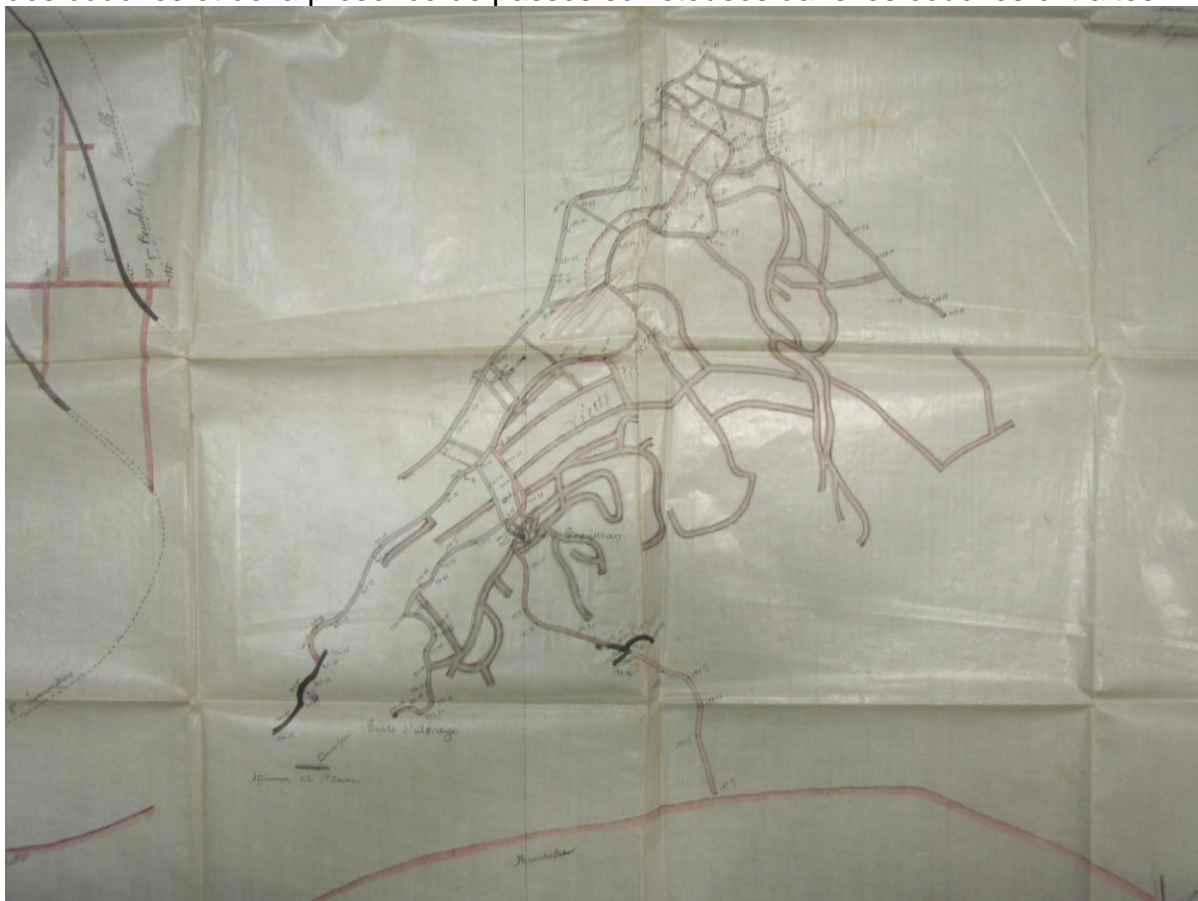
travaux du puits Bayettan, 1876, extrait de plan au 1/1 000^{ème}, archives DREAL.
